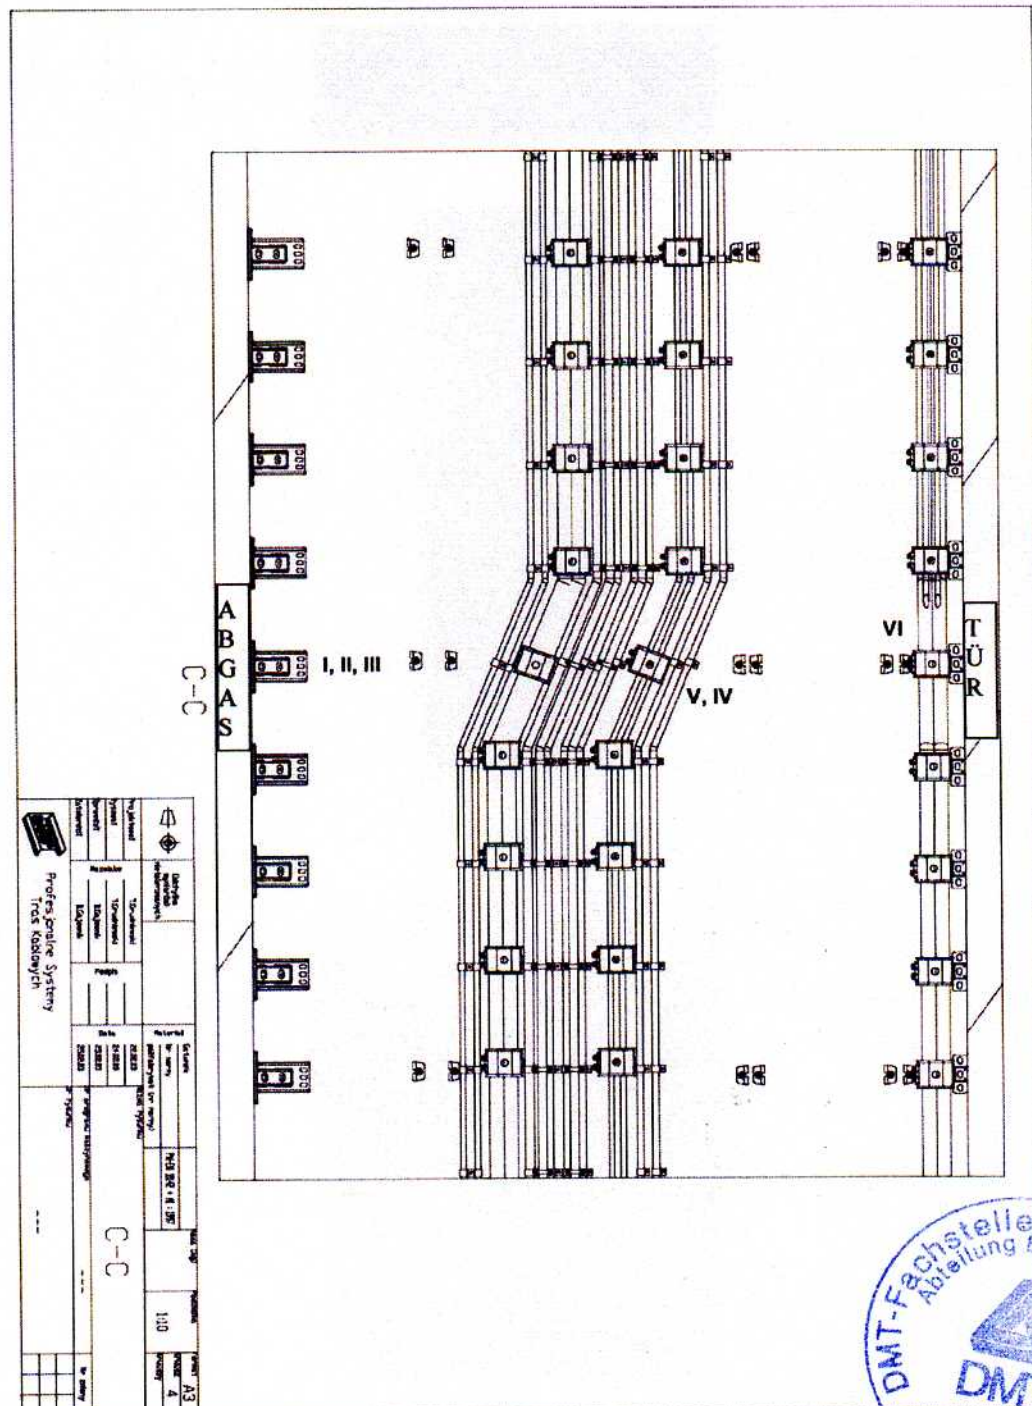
Lage der Thermoelemente im Grundriss
